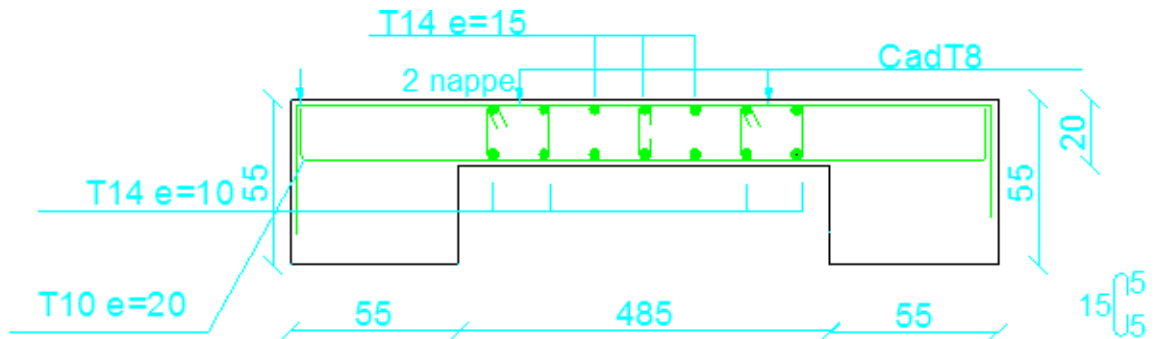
Schéma de ferrailage des voiles type V12 zone 1.
